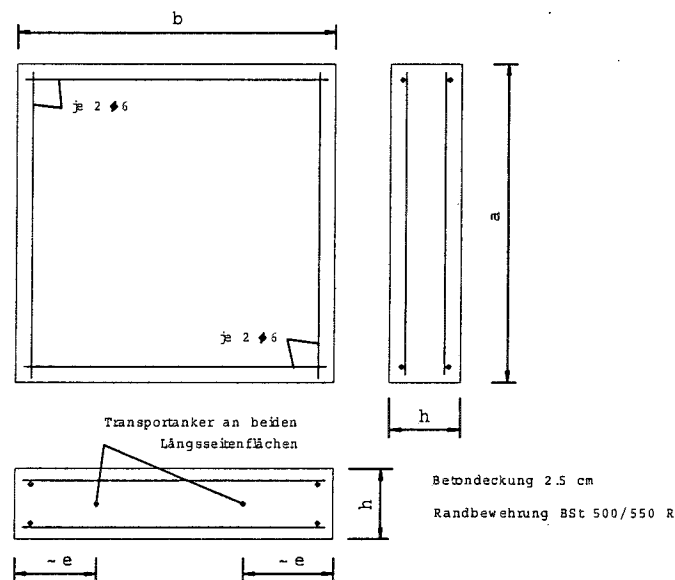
Typische montagebewehrte Betonplatte für zentrische Ausziehversuche im ungerissenen Beton.
